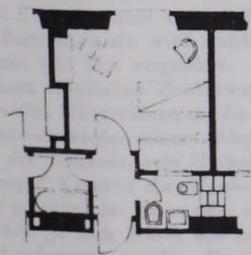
Grundriß eines Einzelzimmers mit Waschräum und WC und einem zwischen jeweils zwei Zimmern liegenden Bad. Columbus-Klinik, Mailand. Arch. Gio Ponti, Mailand
